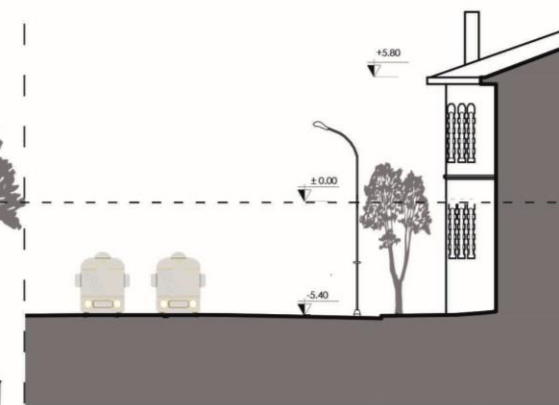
Mekân bölümü 4 plan, kesit, görünüş, fotoğraflar ve deneyim yürüyüşü raporu
